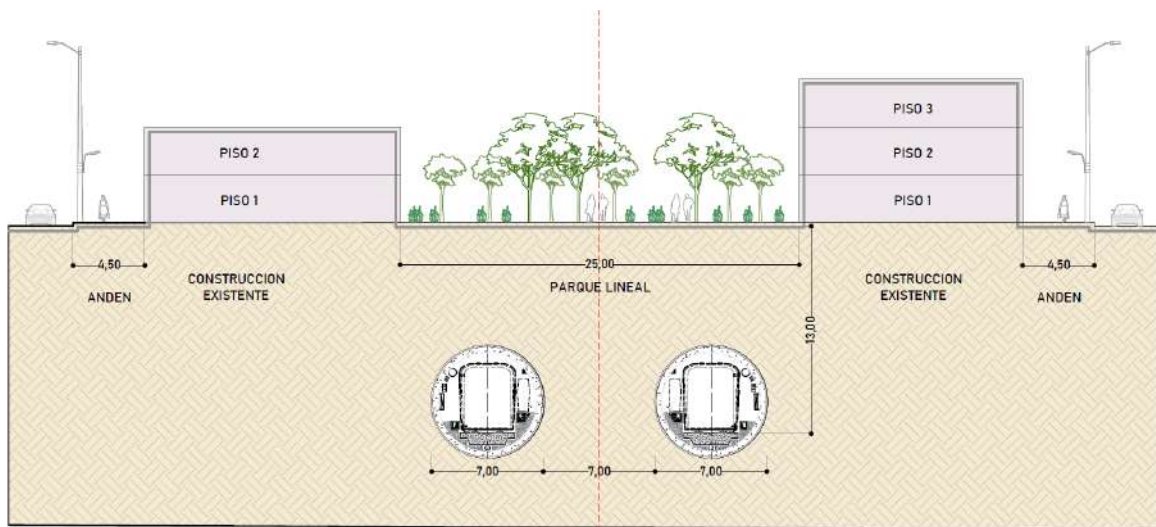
Tramo 6 – Paso bajo el barrio Nueva Corinto
